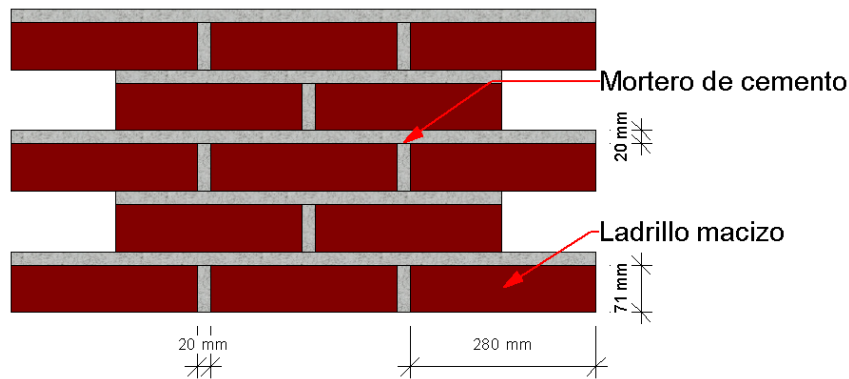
Configuración de los muros perimetrales de albañilería.
